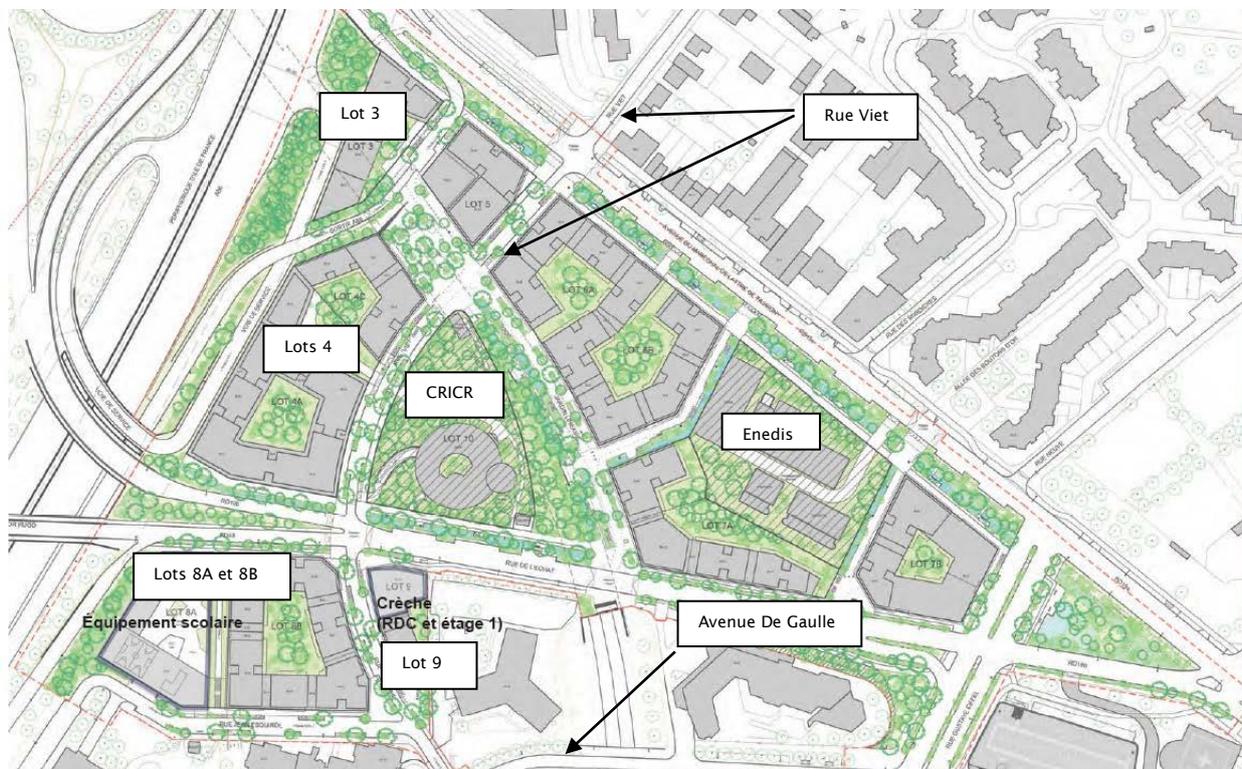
Plan masse de la ZAC 2019 (Source : dossier. Précisions apportées par les rapporteurs)
